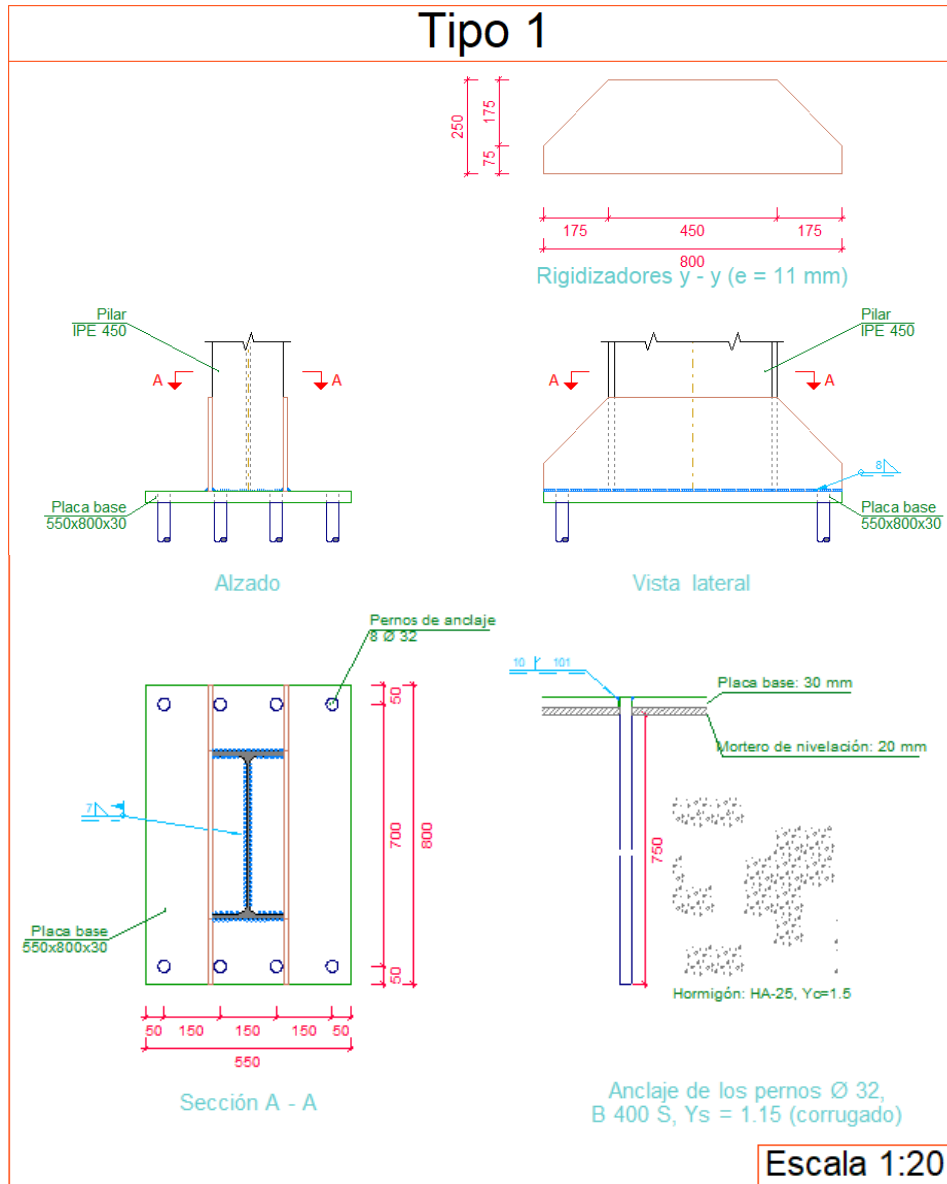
Placa de Anclaje tipo 1 (Fachada y posterior)
